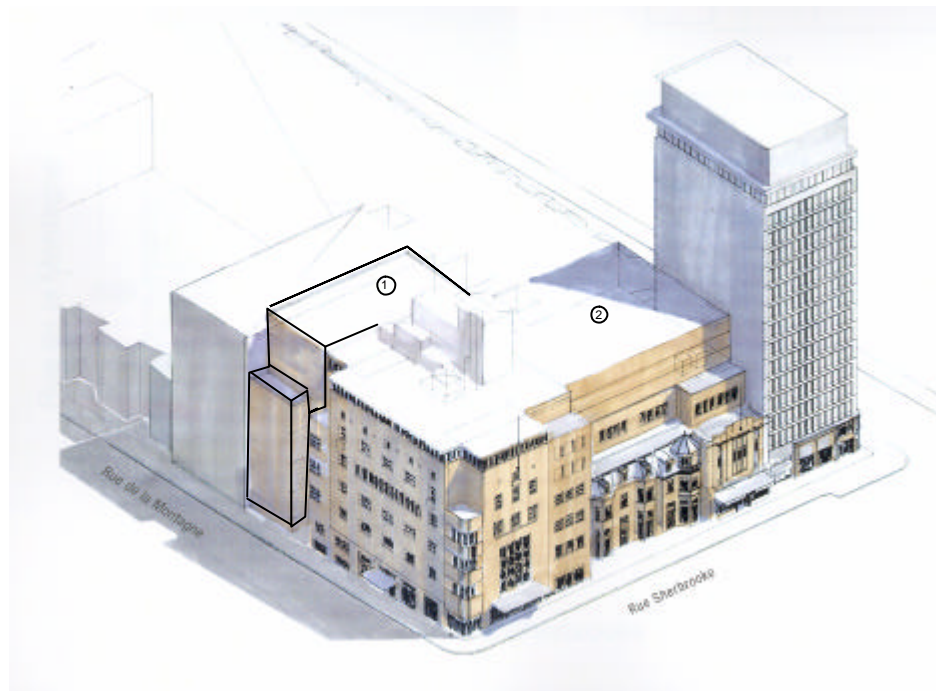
Les additions envisagées dans le plan de développement 2002-2008
